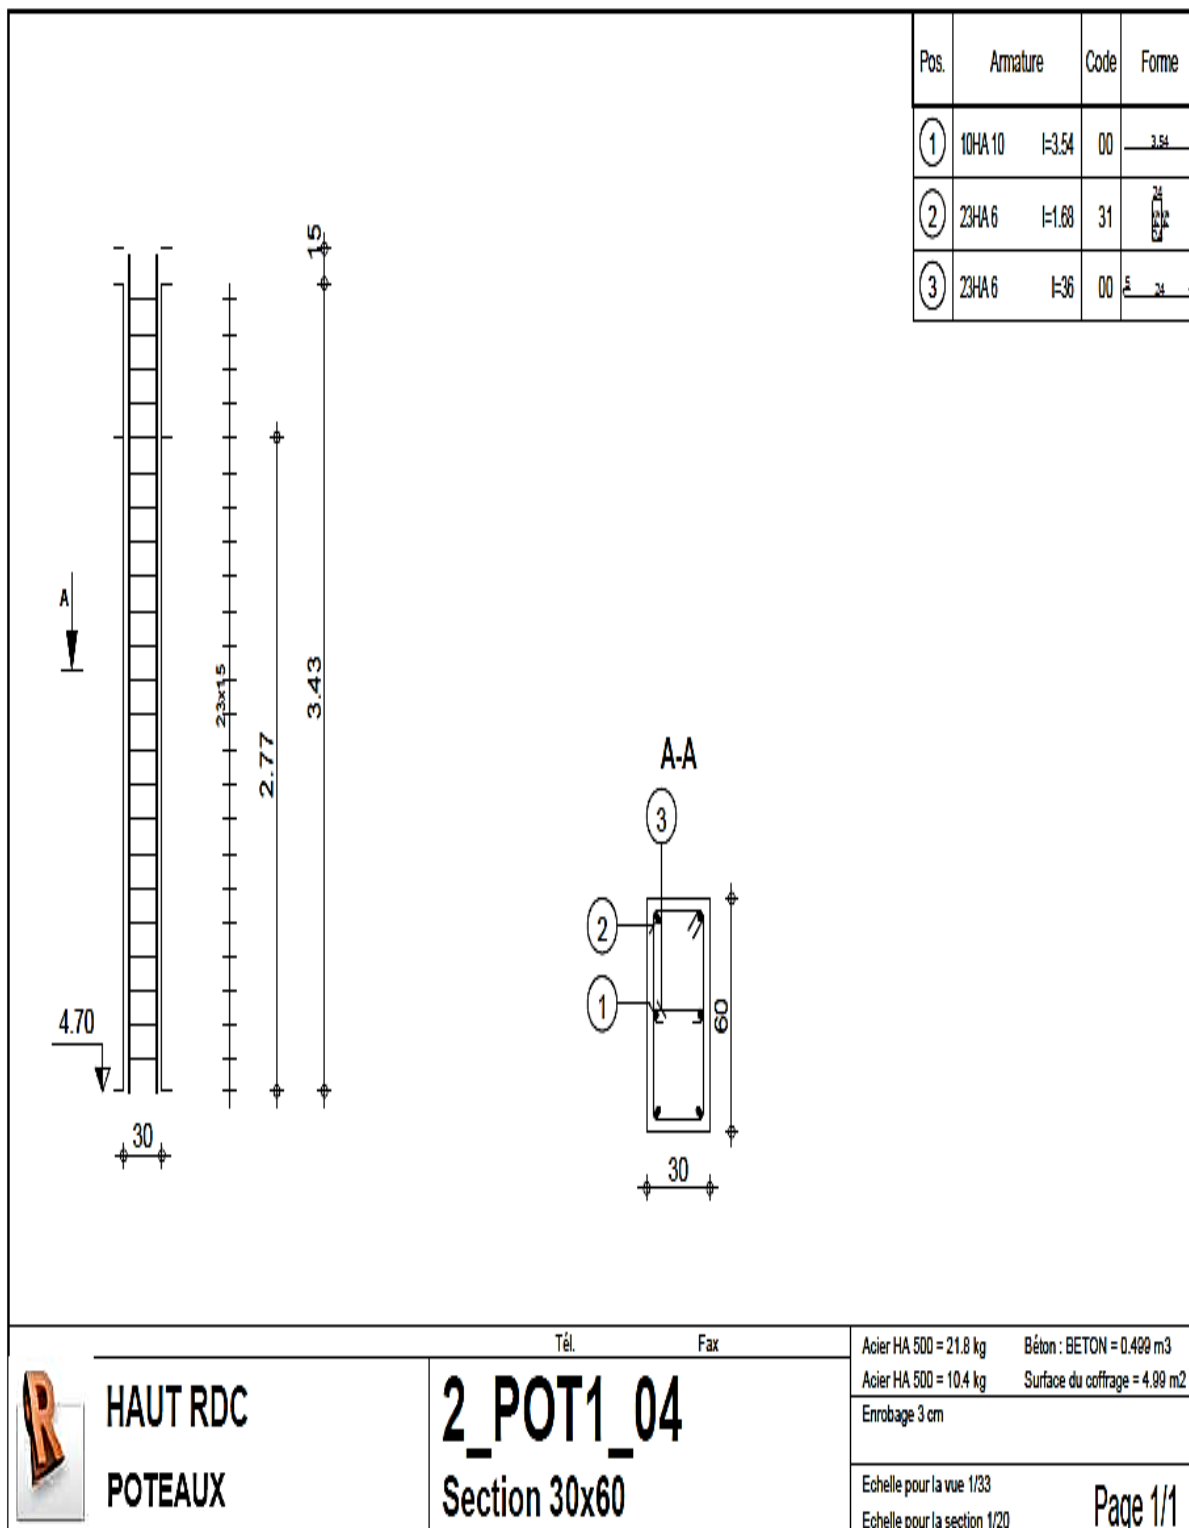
Plan d'exécution du poteau POT1_04 du RDC, Bloc 1, Tranche 1.
